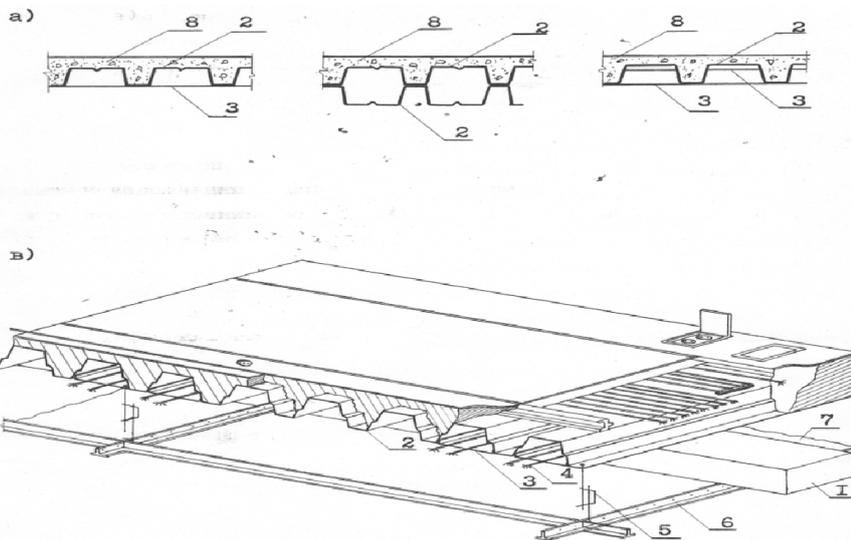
Перекрытия, выполненные на настилах замкнутого профиля
